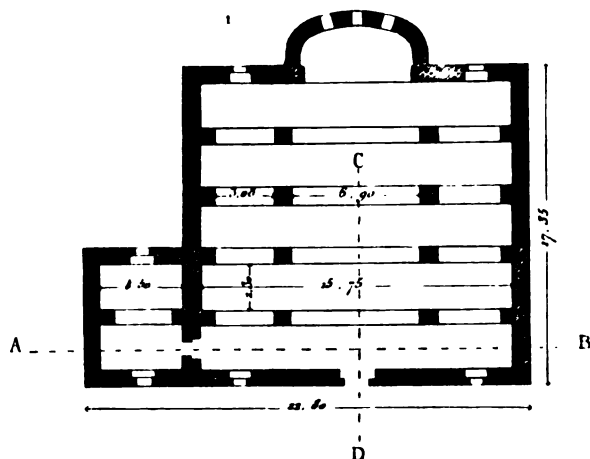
Grundriss der Basilika zu Tafkha.
